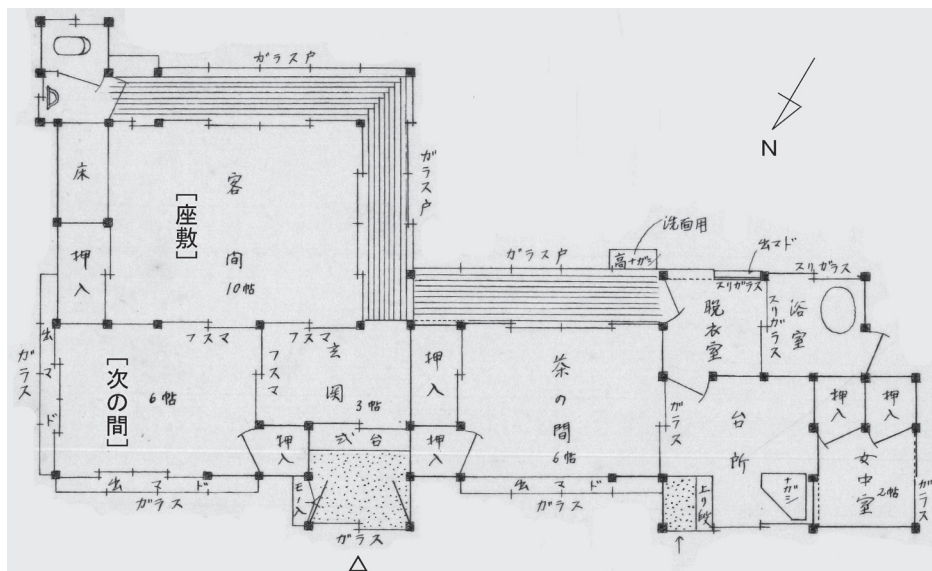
調査の時点で住んでいた横須賀市深田町の家の平面図
